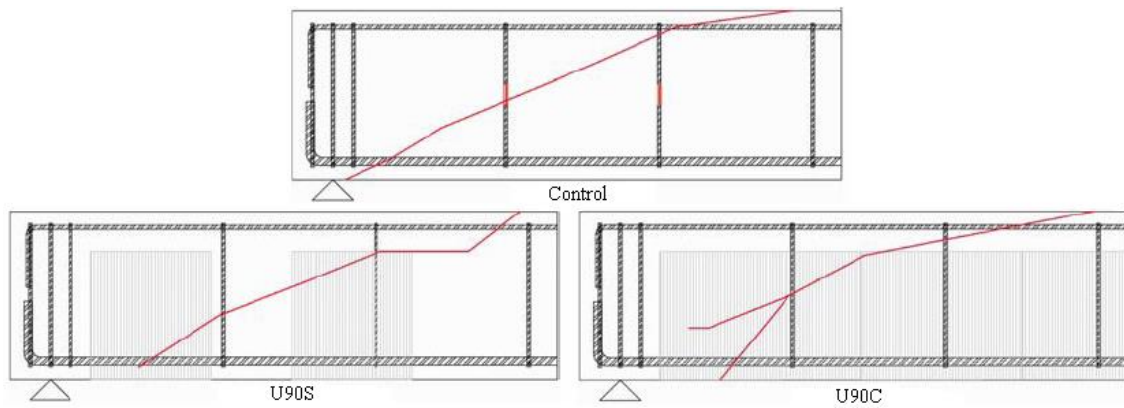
Planos típicos de fisura. (Alzate, 2012)
